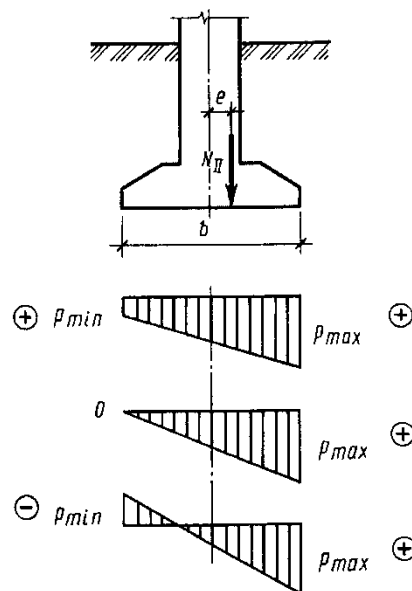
Эпюры давлений под подошвой фундамента при действии внецентренной нагрузки.
